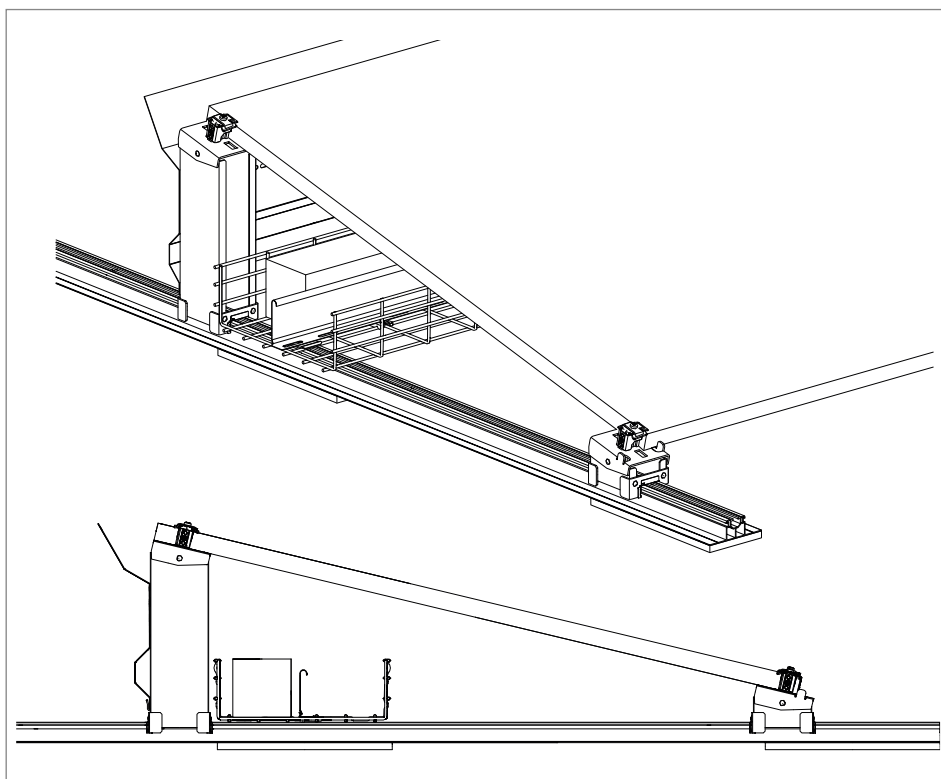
Vista geral da estrutura do sistema, fixação lateral
